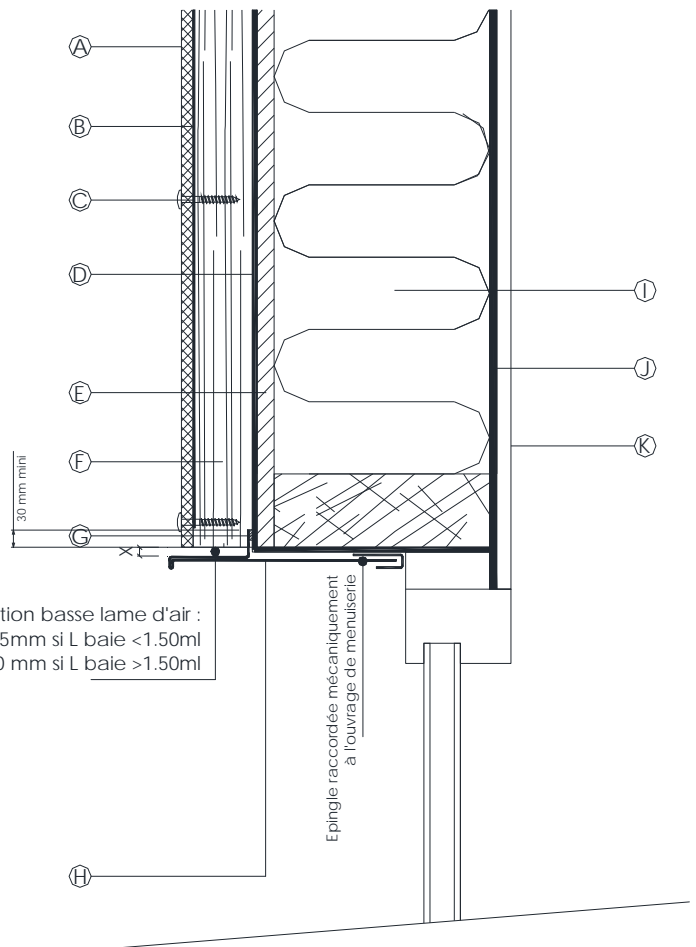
Pose sur COB – Coupe sur linteau de baie
